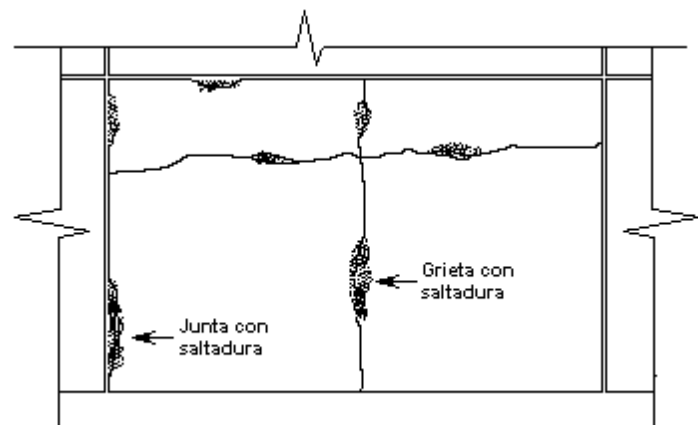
Juntas y Grietas en Pavimentos de Hormigón
